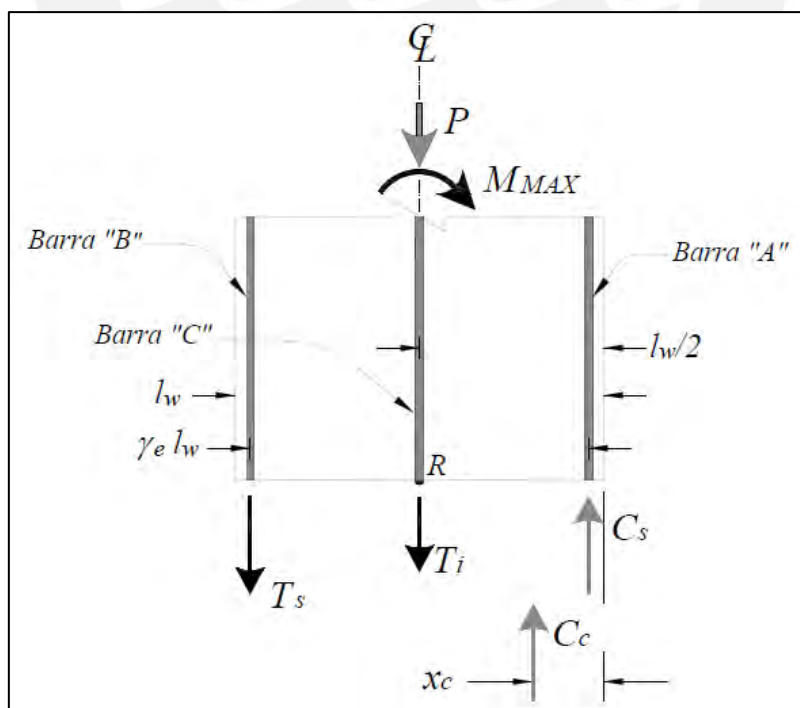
Diagrama de cuerpo libre de muro de concreto estructural
